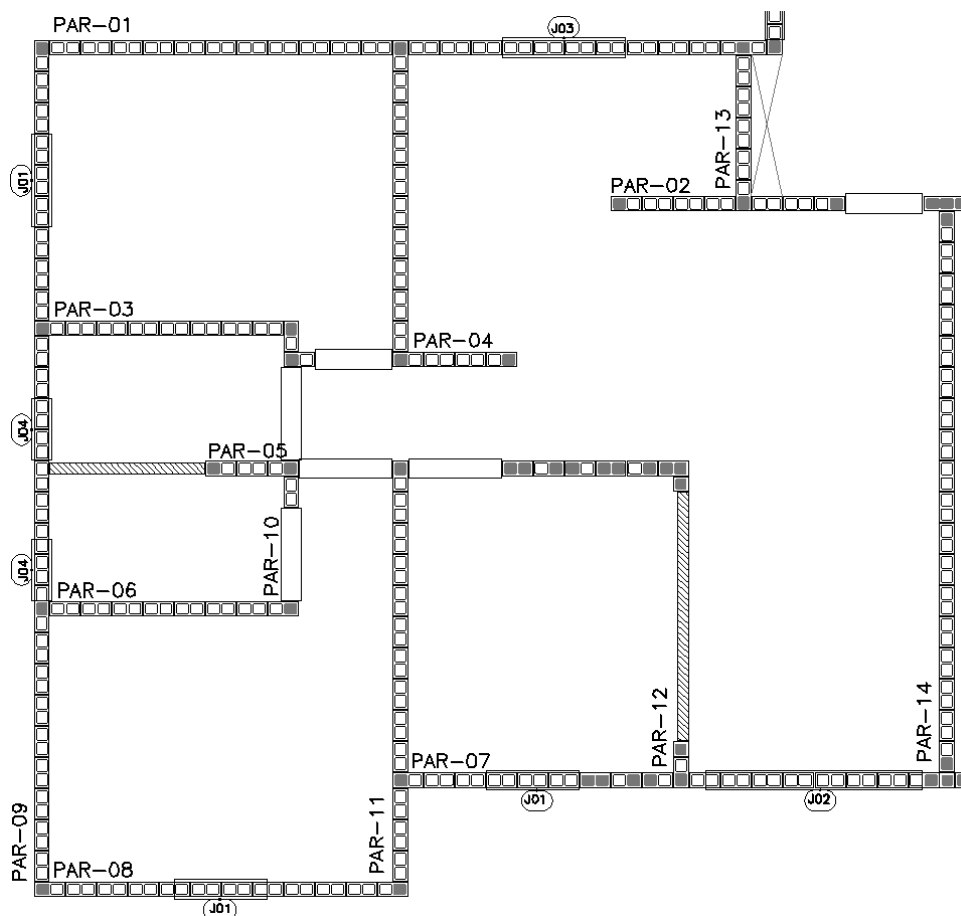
Planta de fiadas do apartamento do Caso II.
